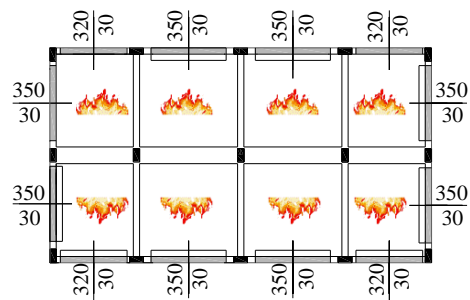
Scenari d’incendio in elevazione per le strutture test SI400, SI800, SI2400, SI.R e SI.LR.
